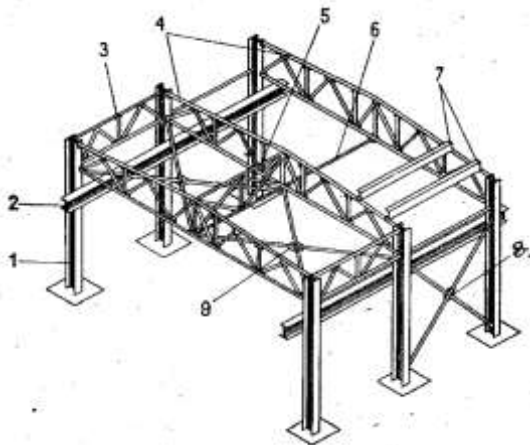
Елементи сталевих каркасів: 1 – колони; 2 – підкранові балки; 3 – вертикальні зв'язки між фермами; 4 – кроквяні ферми; 5 – вертикальні зв'язки (в гребені ферми); 6 – розтяжки (на рівні нижнього поясу ферм); 7 – прогони; 8 – вертикальні хрестові зв'язки (між колонами); 9 – горизонтальні хрестові зв'язки (на рівні нижнього поясу ферм).
